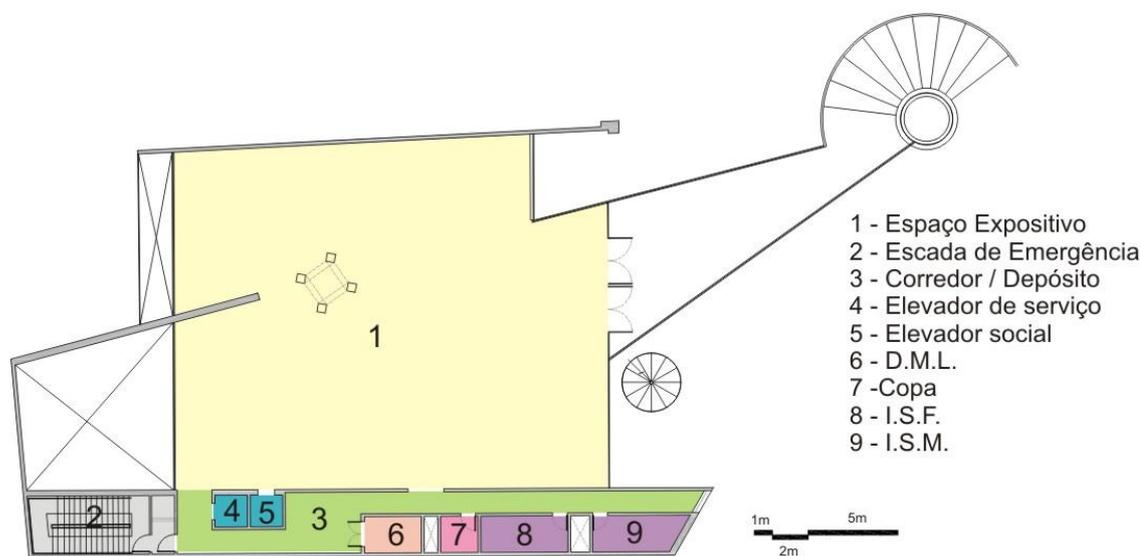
Planta Esquemática do Segundo Pavimento (FONTE: FCC com intervenção do Autor)
